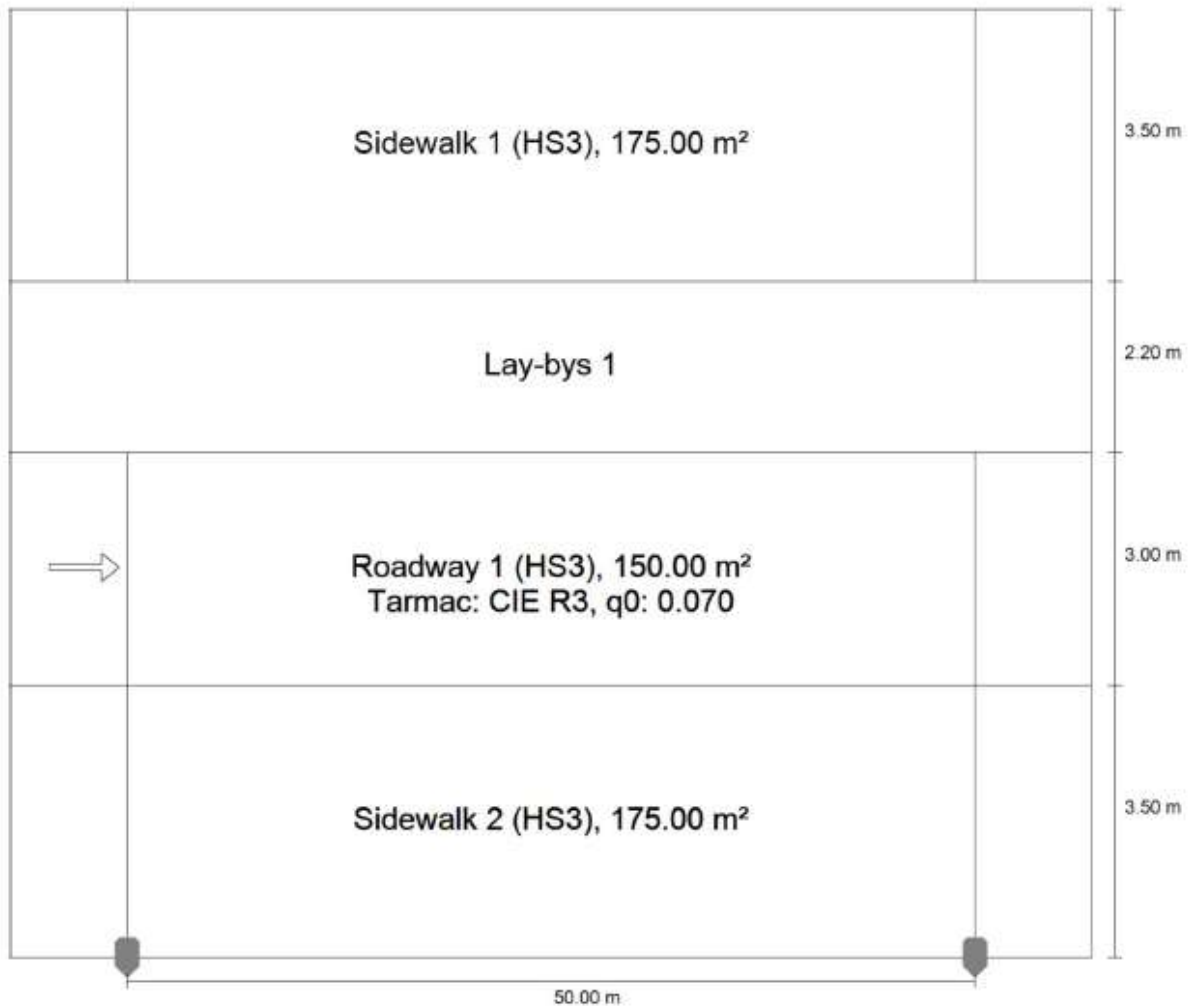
Dimensiones en planta planta calle transversal. Fuente: Dialux.
